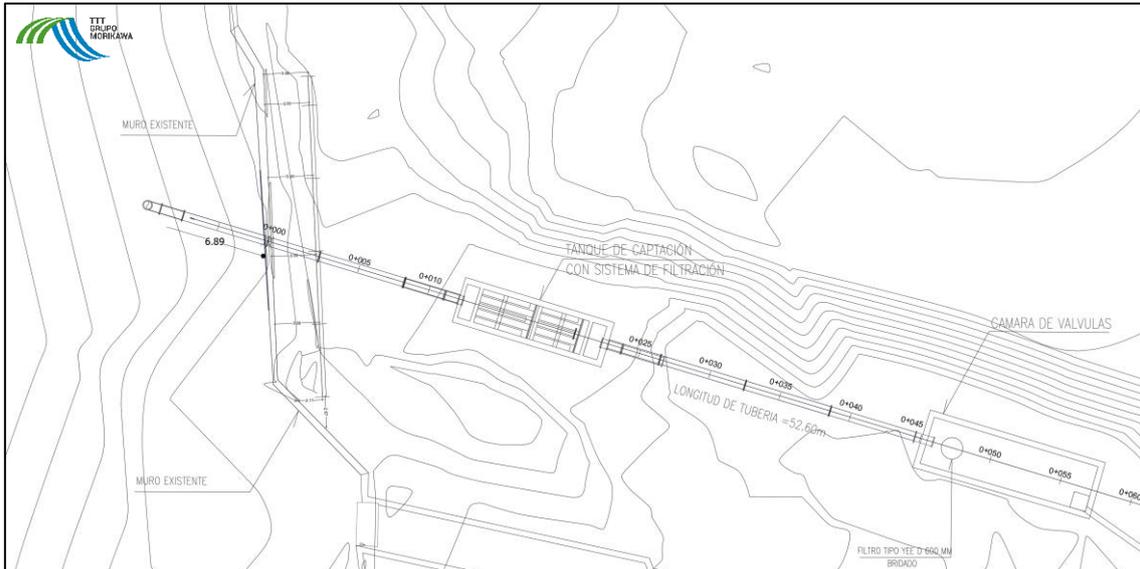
VISTA EN PLANTA UBICACIÓN TANQUE DE CAPTACIÓN CON SISTEMA DE FILTRACIÓN / FUENTE: PROPIA
